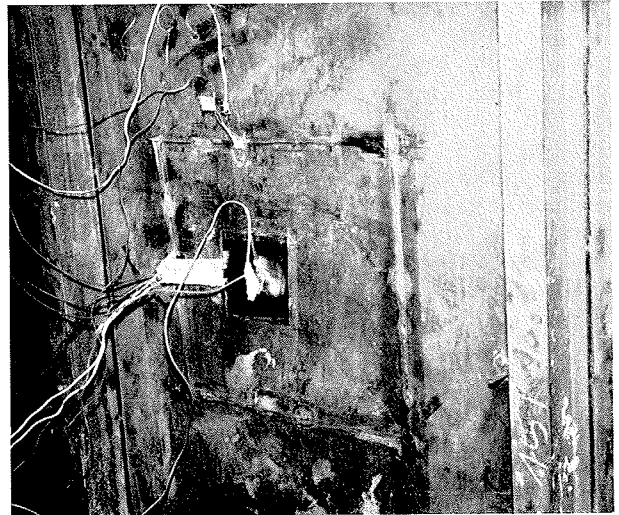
Temperatur- und Wärmeverlustmessung auf der wieder eingeschweißten Blechplatte.
